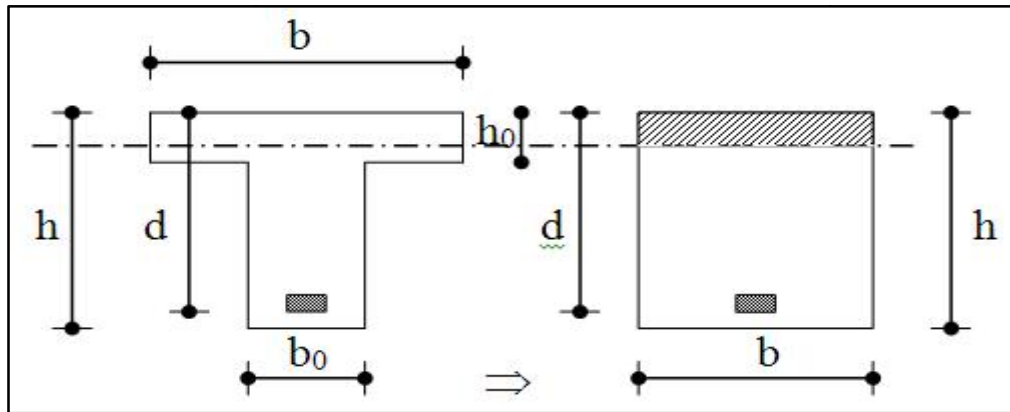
Coupe de Section Rectangulaire et Section en T
